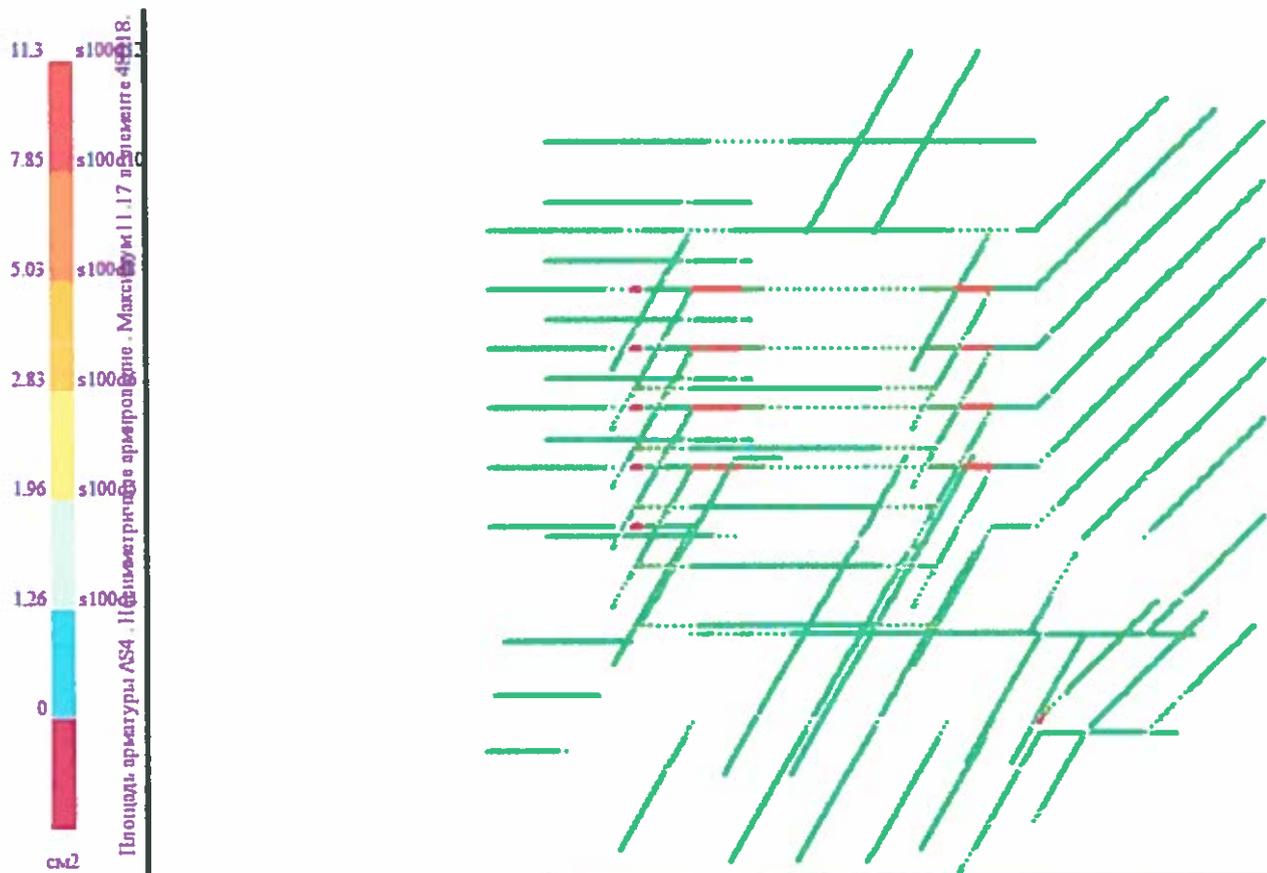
Необхідна площа арматури AS4 у балках
